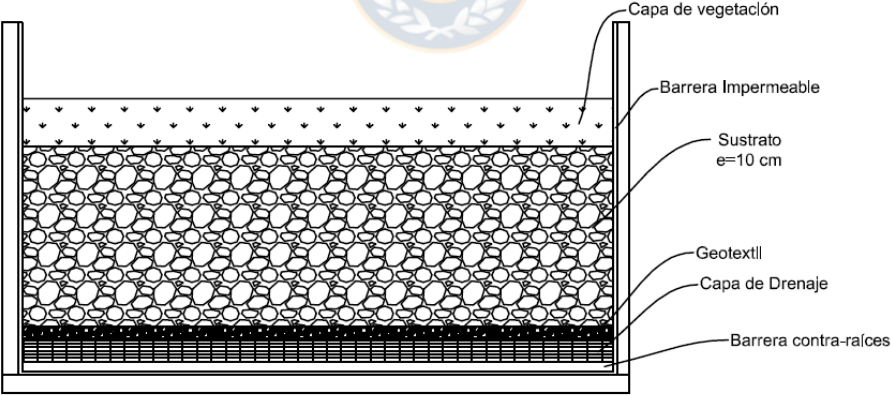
Corte del Módulo de Cubierta verde. Fuente: Elaboración propia
